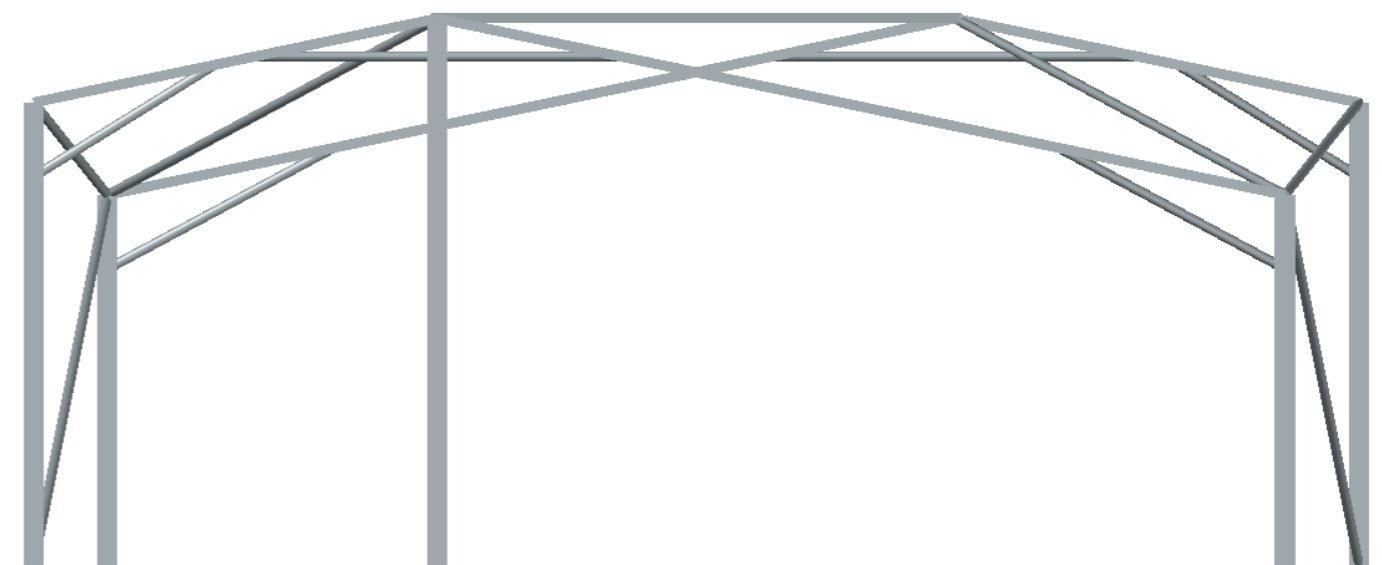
Vista frontal de la estructura. (Fuente: Elaboración propia)
